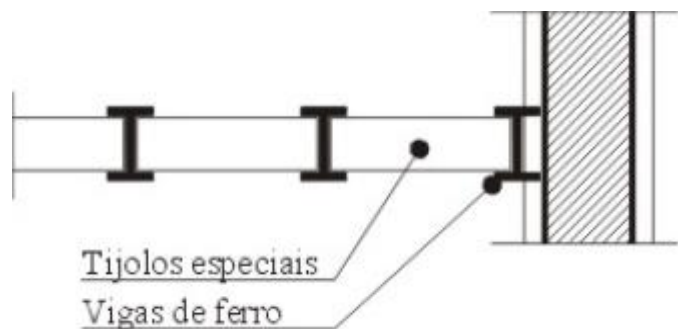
Laje constituída por vigas de perfil “I” e por tijolos cerâmicos especiais
